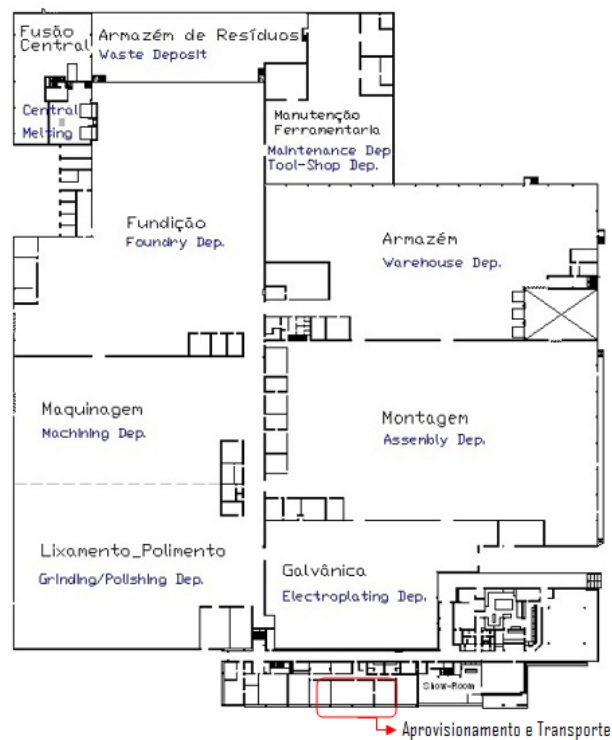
Planta da fábrica de Albergaria-a-Velha.
